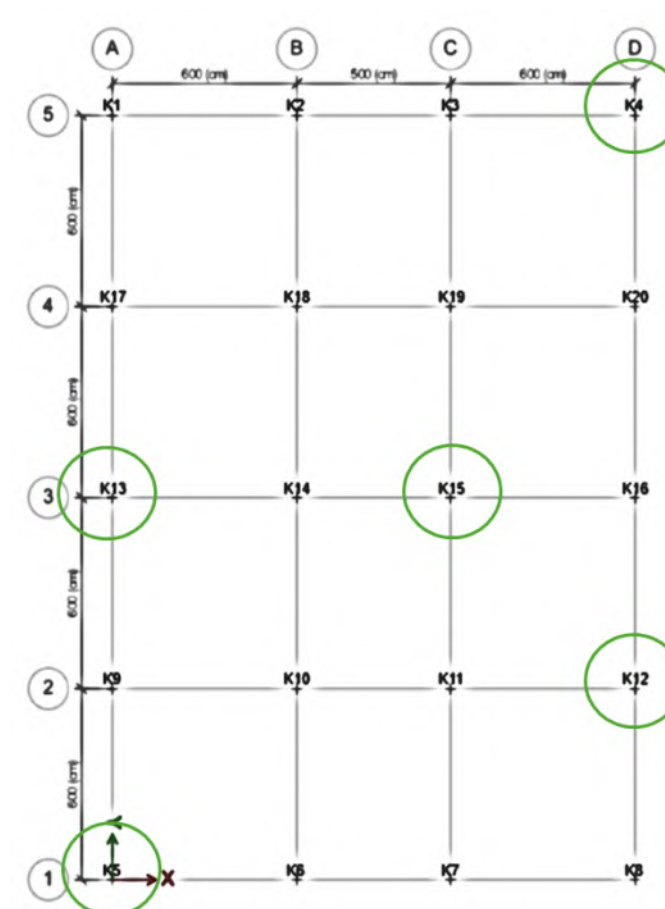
Distribución de los aisladores LRB, vista en planta.
